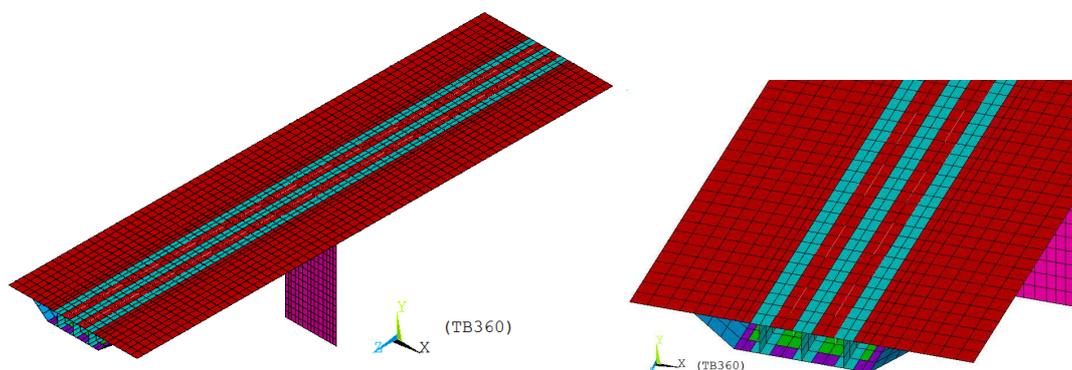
Estrutura da OAE projetada para a utilização do TB-360.
